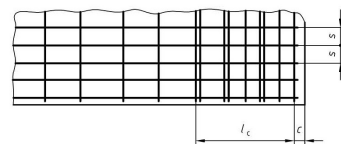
Konstruktive Maßnahmen im Stahlbetonbau [1]
